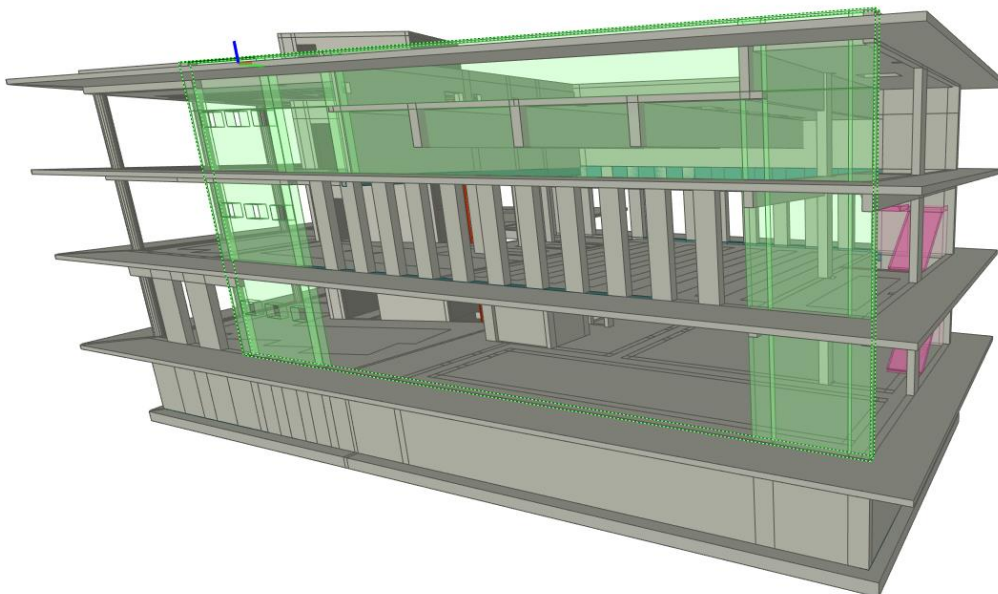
Parede de suporte das lajes do auditório e de cobertura na fachada principal.
